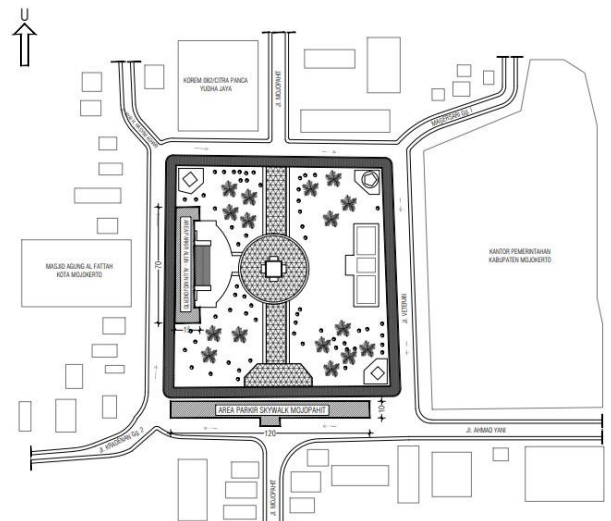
Lay Out Existing ruas jalan Mojopahit segmen 1
